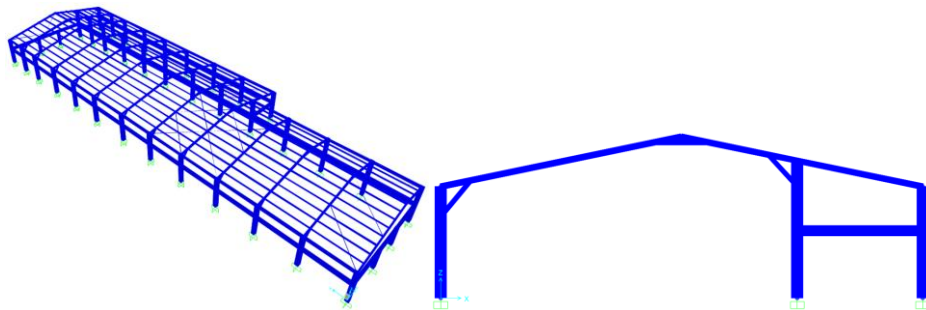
25: Vista general de la propuesta de reforzamiento de la edificación
